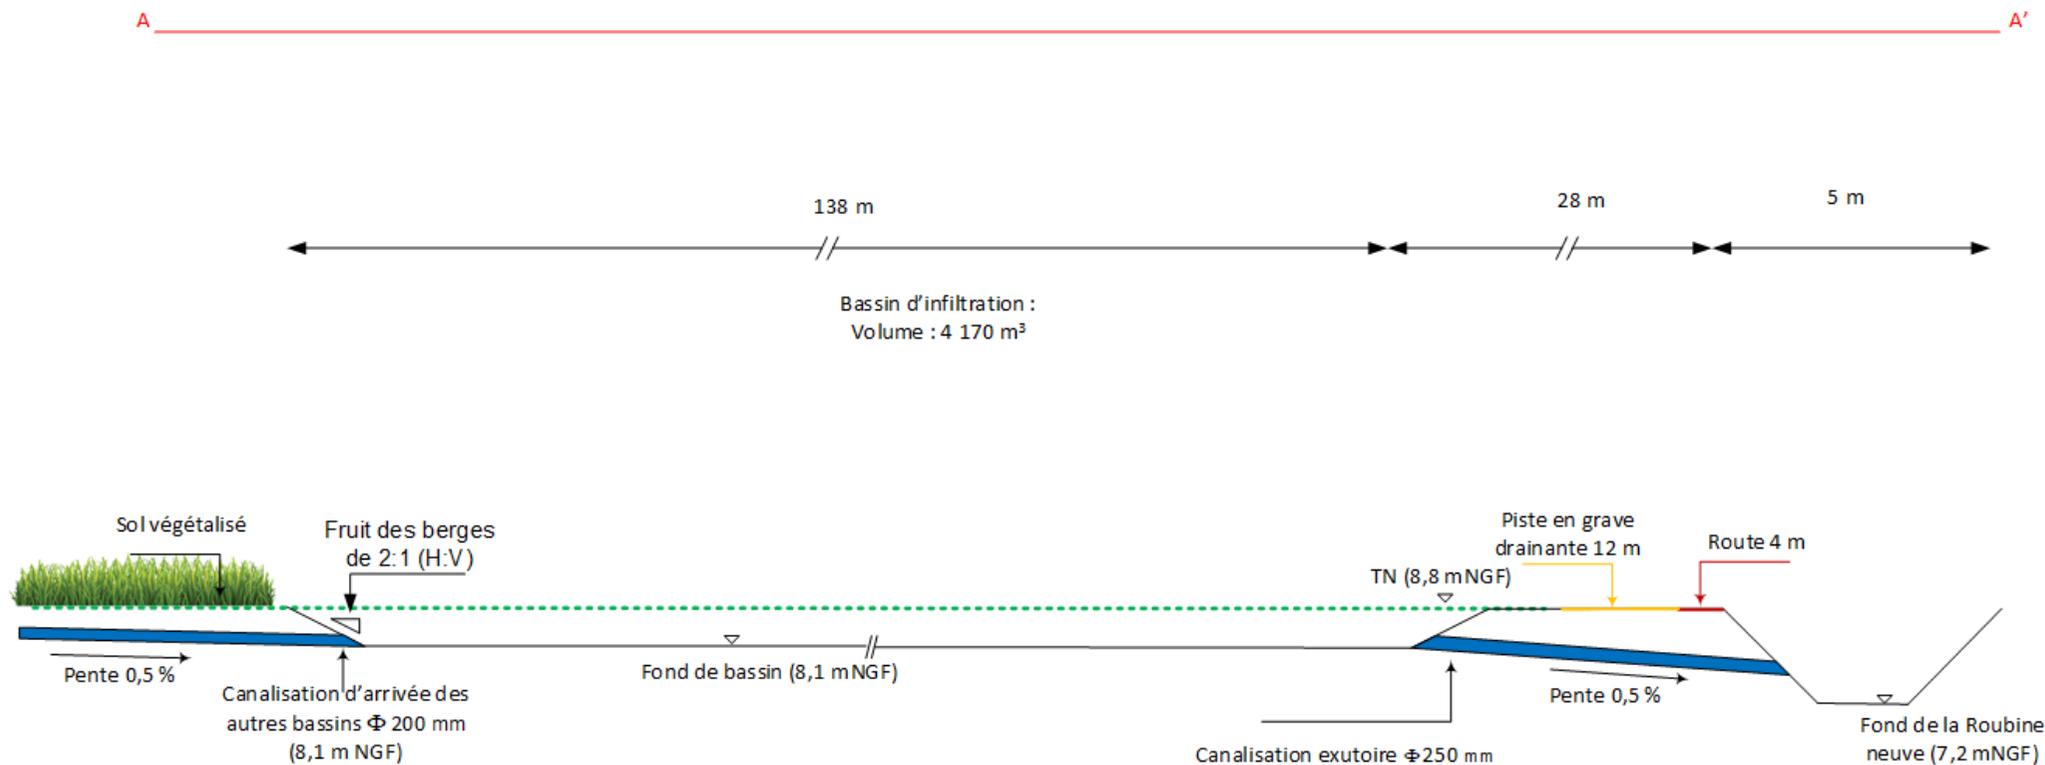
Coupe longitudinale du bassin de rétention au sud du projet
